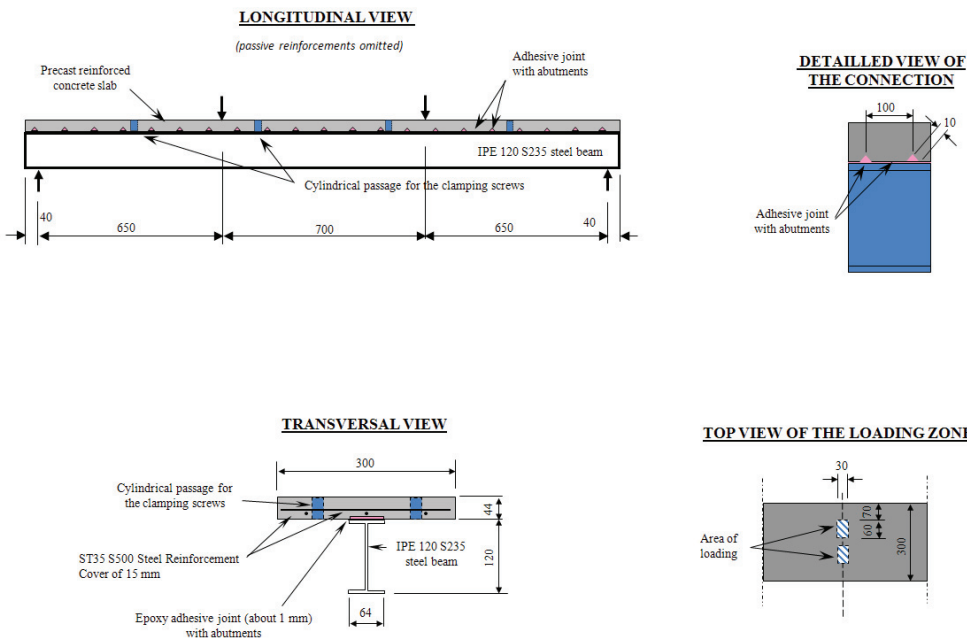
Géométrie, ferrailage et chargement de la poutre AB5
